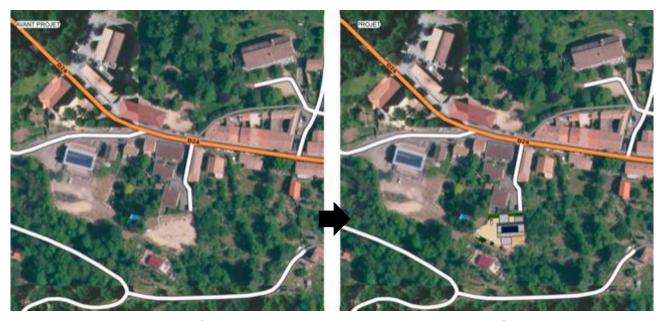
Schéma d'implantation du projet (fond : photo aérienne)
